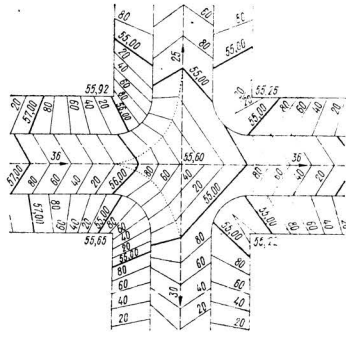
Вертикальная планировка перекрестка, одна из улиц которого проходит по гребню.
